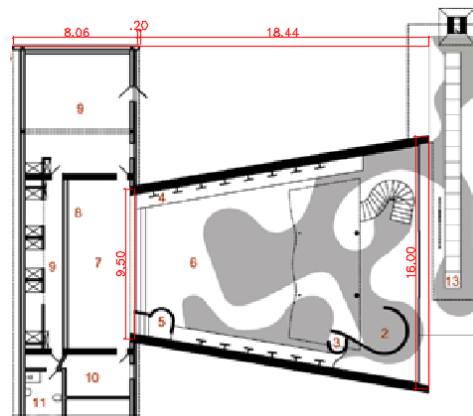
Planta Baixa. Fonte: Adaptada[6]
